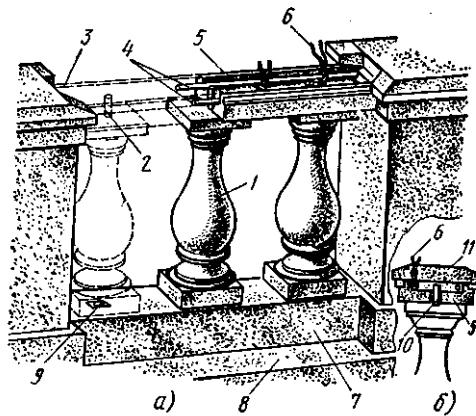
Установка и крепление балюсина (а) и поперечный разрез поручня (б):
